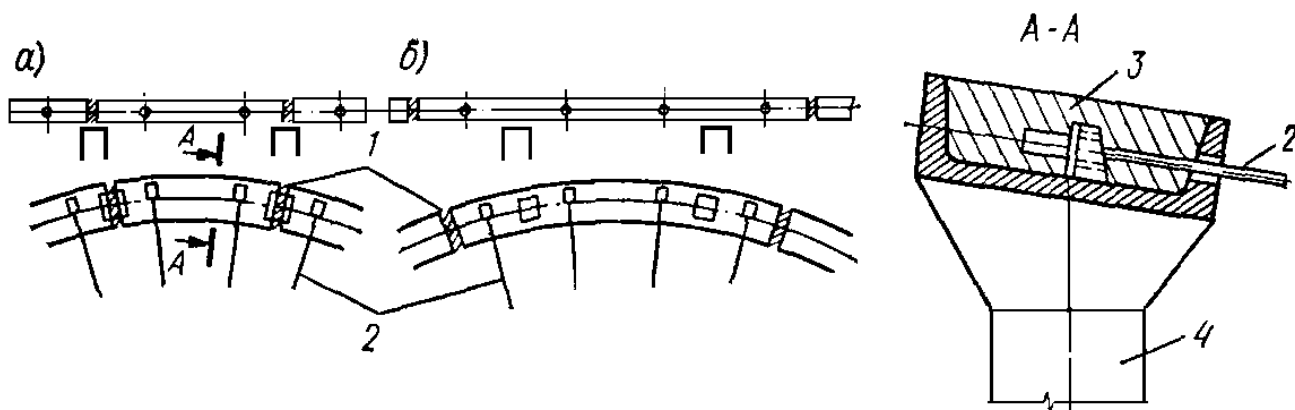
Наружные железобетонные сборно-молитные кольца висячих одноярусных оболочек
